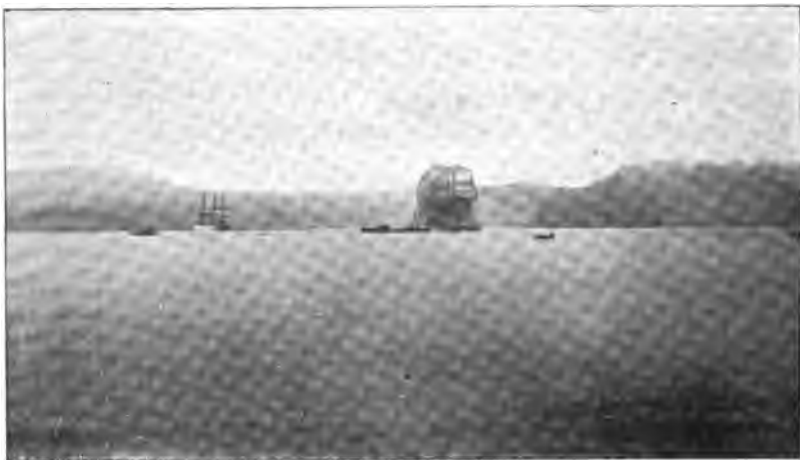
Pont construit aux Nouvelles Galles du Sud par l'Union Bridge Co., de New-York
